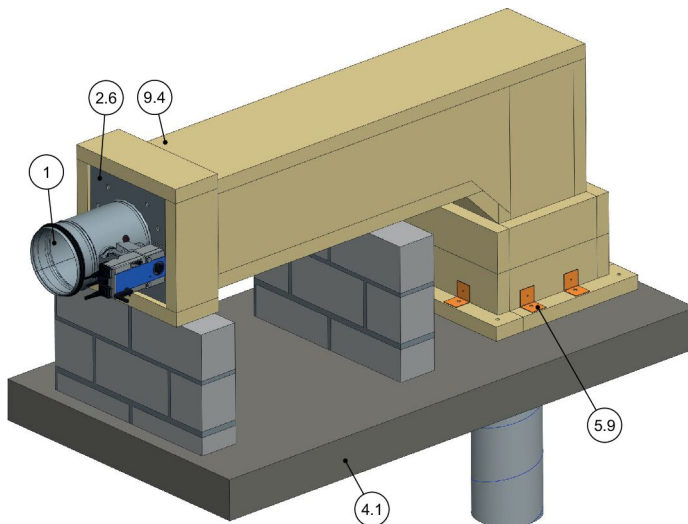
Installazione a secco senza malta lontano da soffitti pieni a soletta, con kit d'installazione WE2
